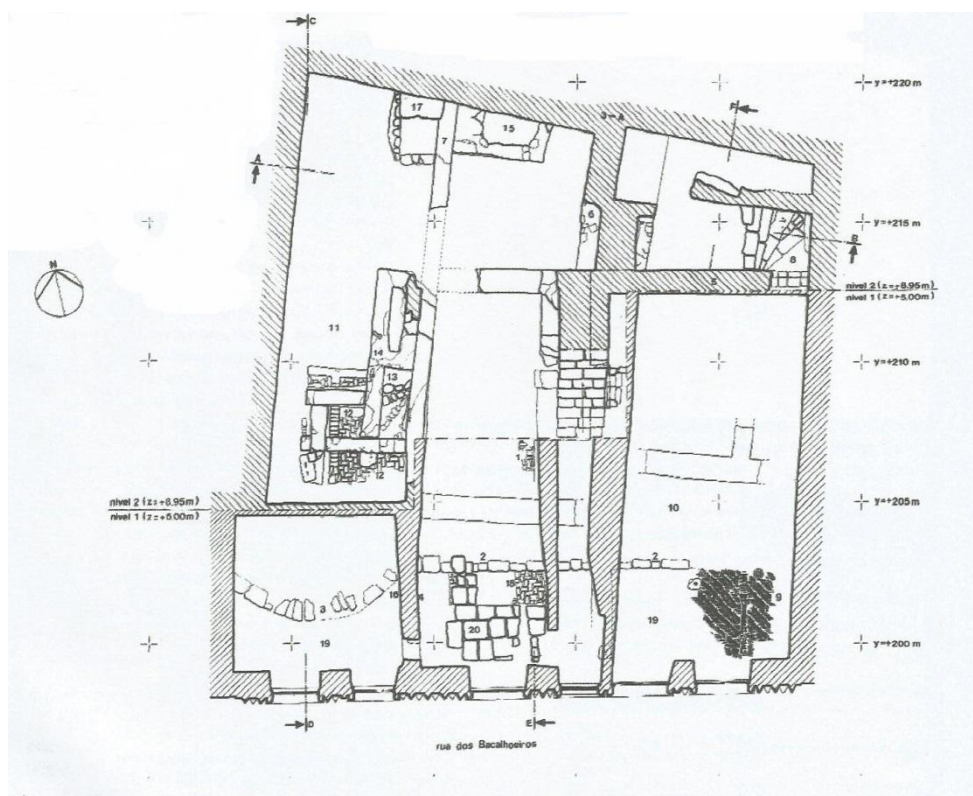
Desenho da plana da escavação (Fonte: Sepúlveda e Amaro, 2007:4)
